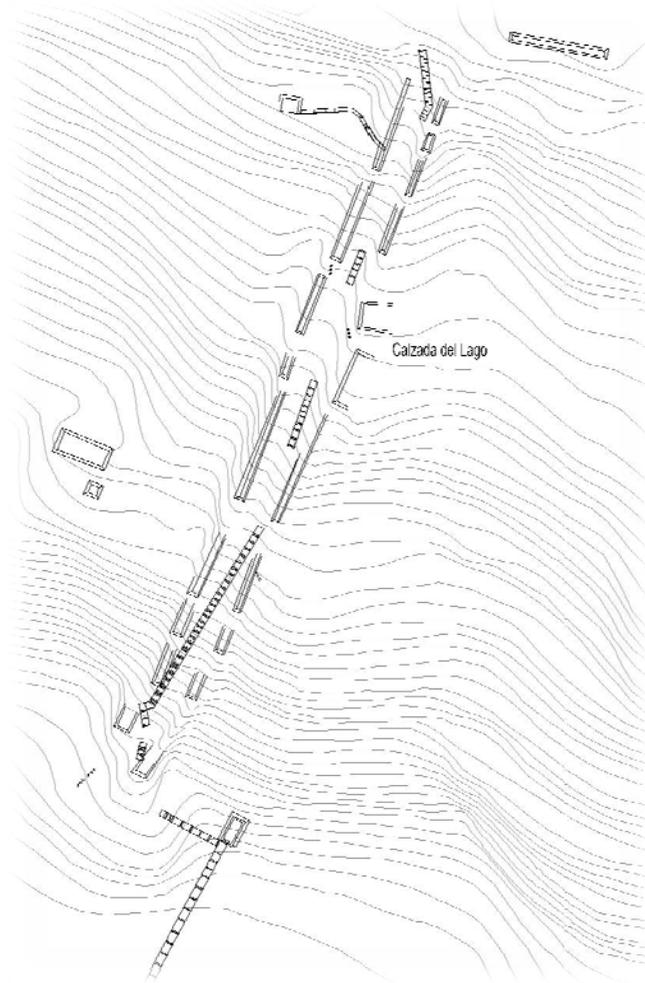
Vista en planta de la calzada del lago. Fuente: RAE-2007
